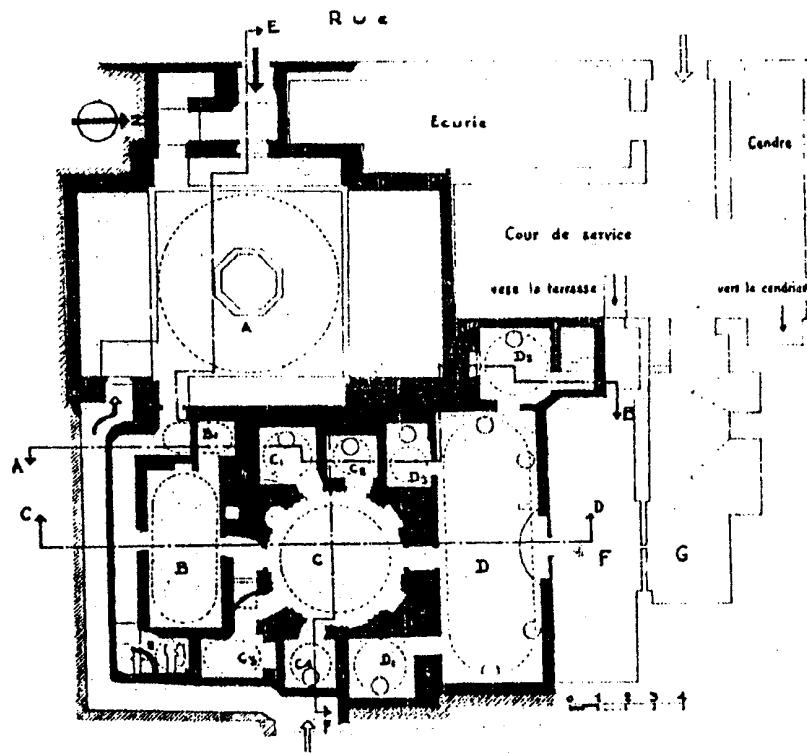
مسقط أفقي لحمام المملوك بالقاهرة (عن Pauty)
